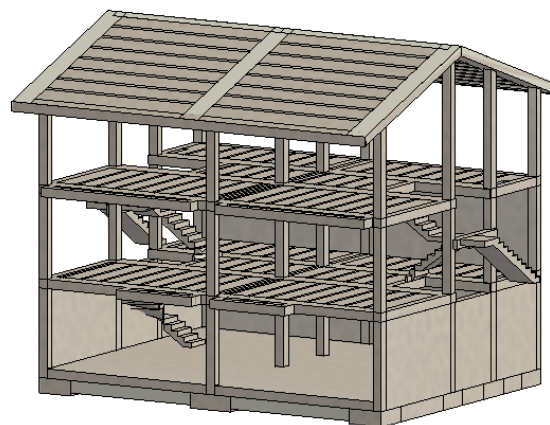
Estructura de la vivienda pareada en Revit en hormigón armado.
